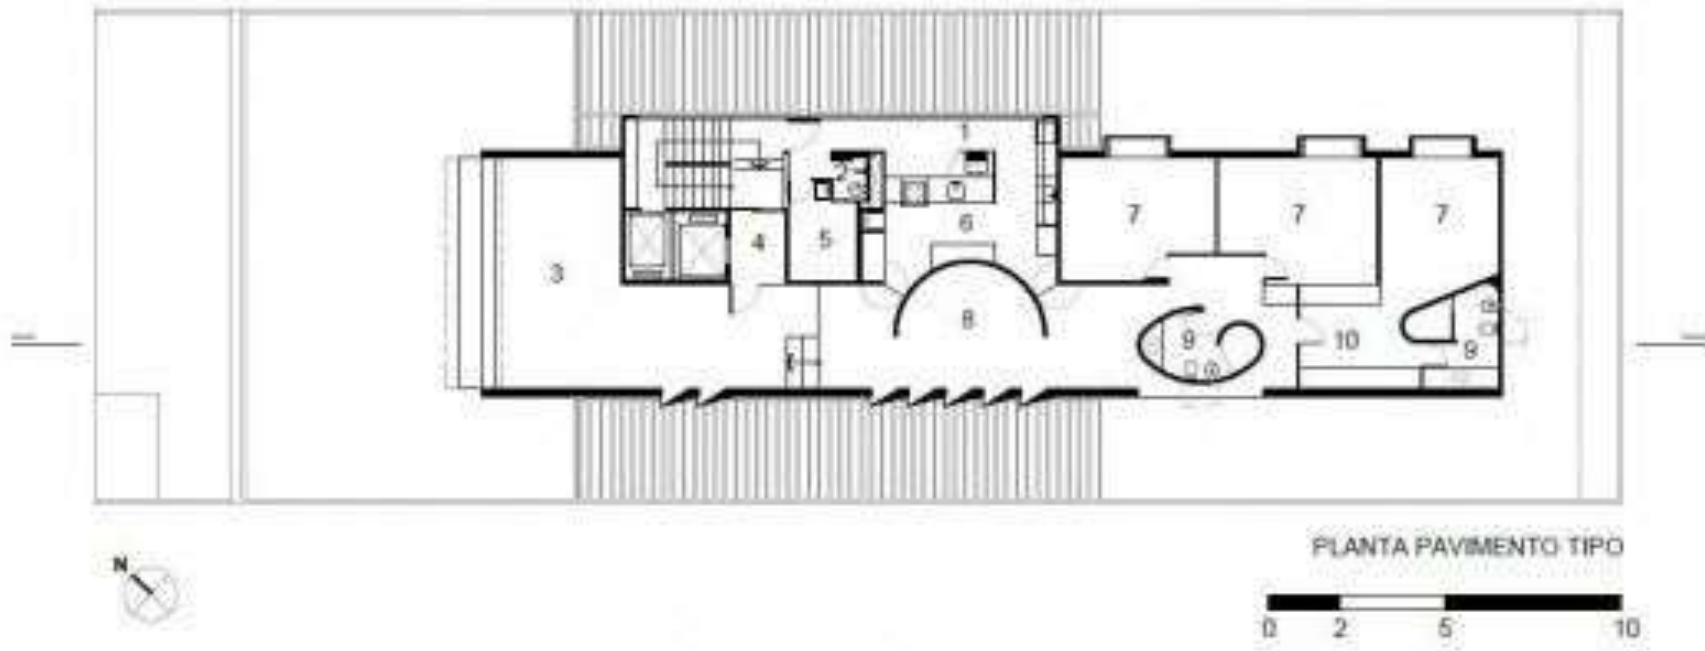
Edifício Guaimbê, planta pavimento tipo [AVILA, Débora Saldanha de. *Habitacões Coletivas Verticais de Paulo Mendes da Rocha*]-<<https://vitruvius.com.br/index.php/revistas/read/arquitextos/17.194/6127>> Acesso em 14 jan 2022
